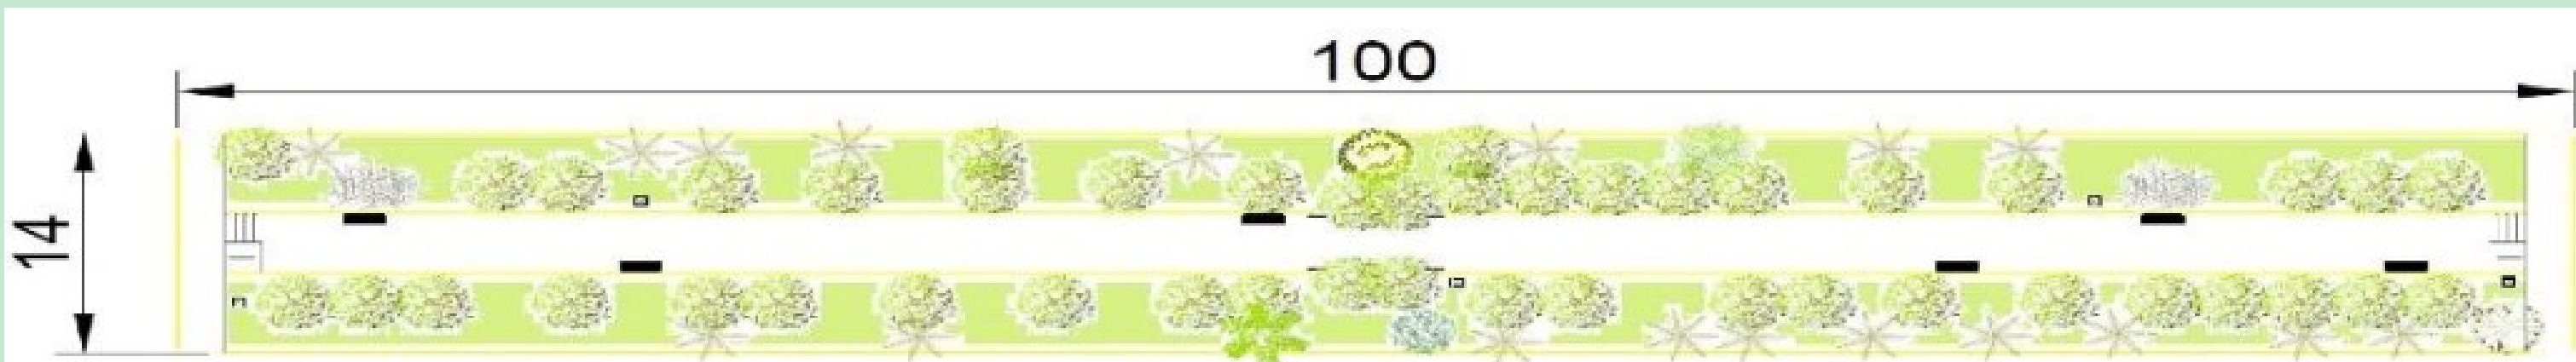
Plano vista en planta de árboles en el tramo 1 de la calle Costa Rica - Ignacio Allende. Colonia 27 de Septiembre.
